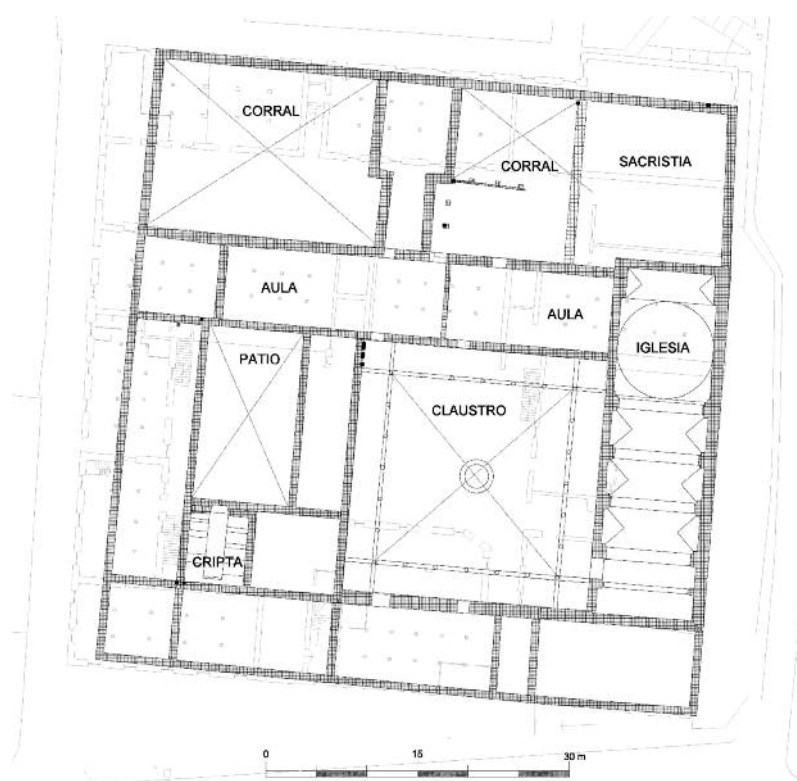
Reconstrucción de la planta del Colegio de San Laureano. Siglos XVII-XVIII.
